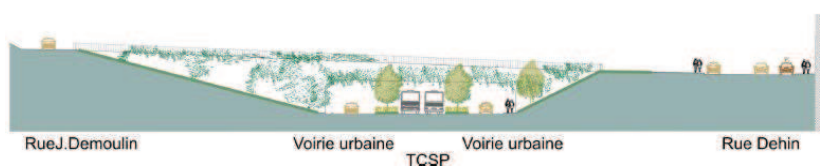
et 17 Plan et coupe PLURIS B. Bianchet
